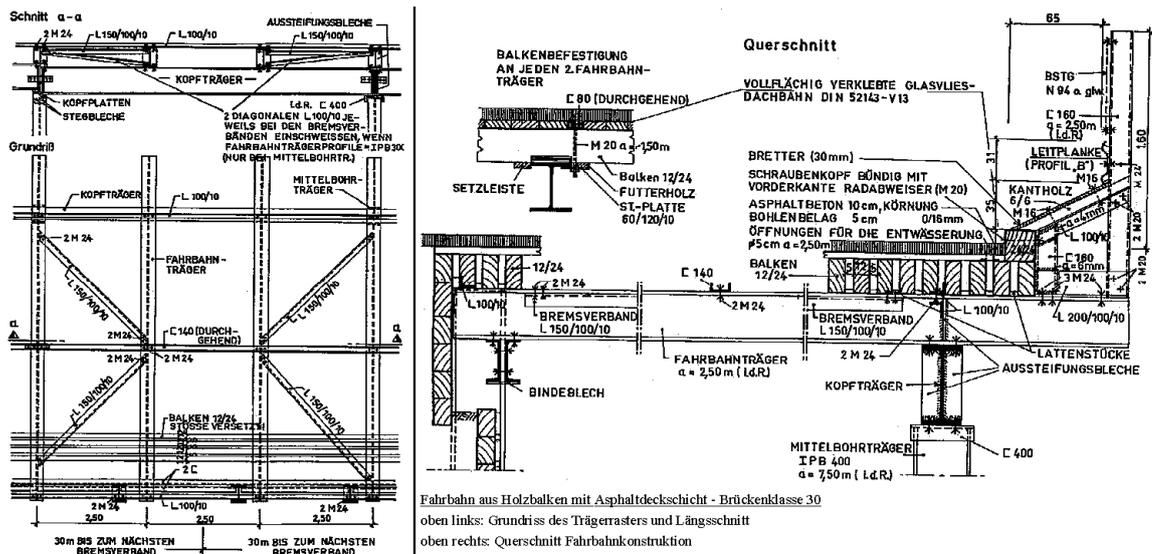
Hilfsbrückenkonstruktion (Beispiel)
